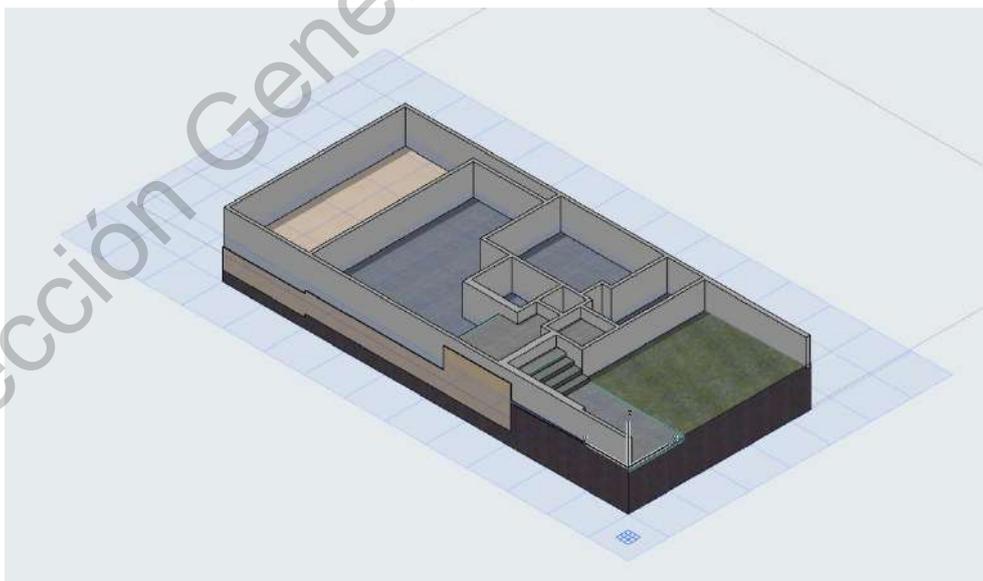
Muros y Suelos de Planta Baja de proyecto 003.
